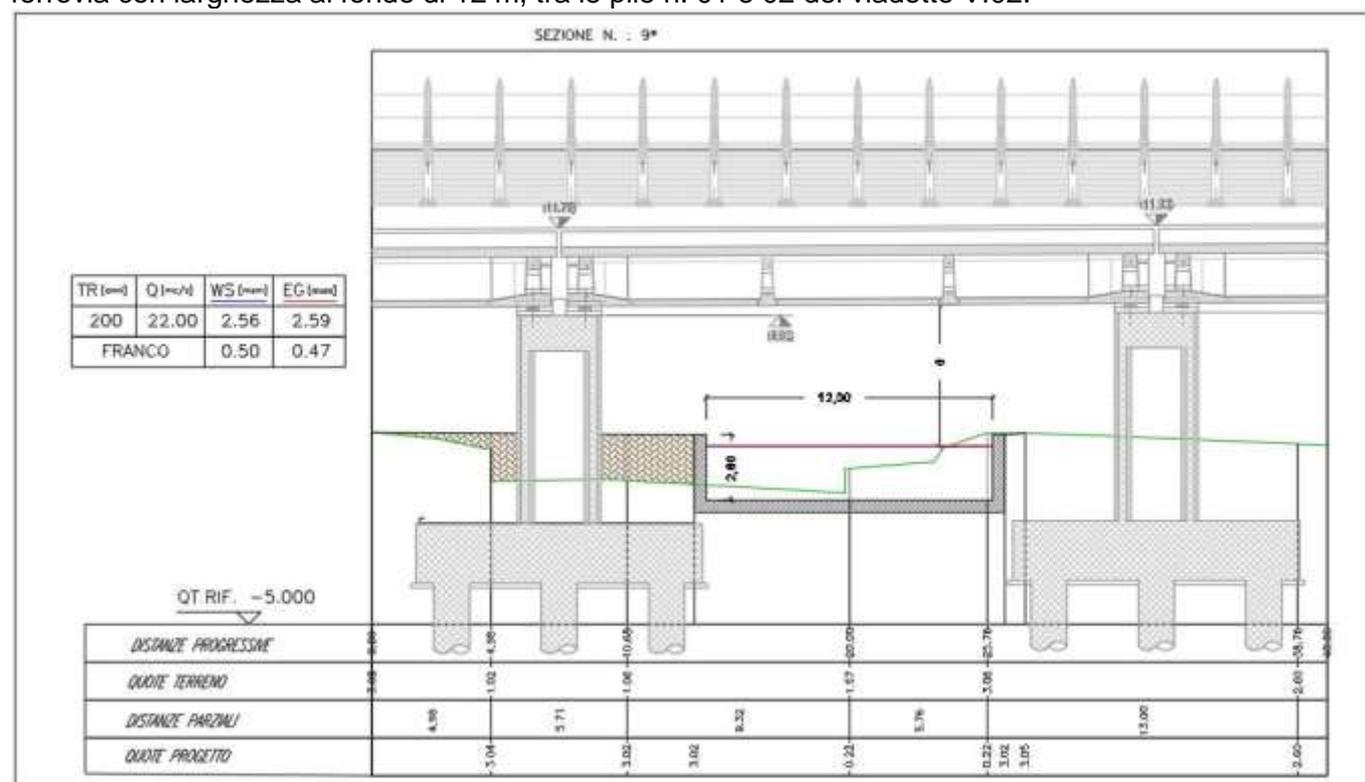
Sezione in corrispondenza dell'opera di attraversamento in progetto (VI01) pk 3+426,29 (da PD).
